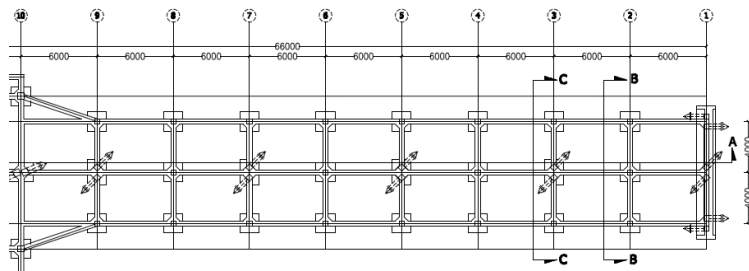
Desain Awal Pelat Dermaga menggunakan two way slab
